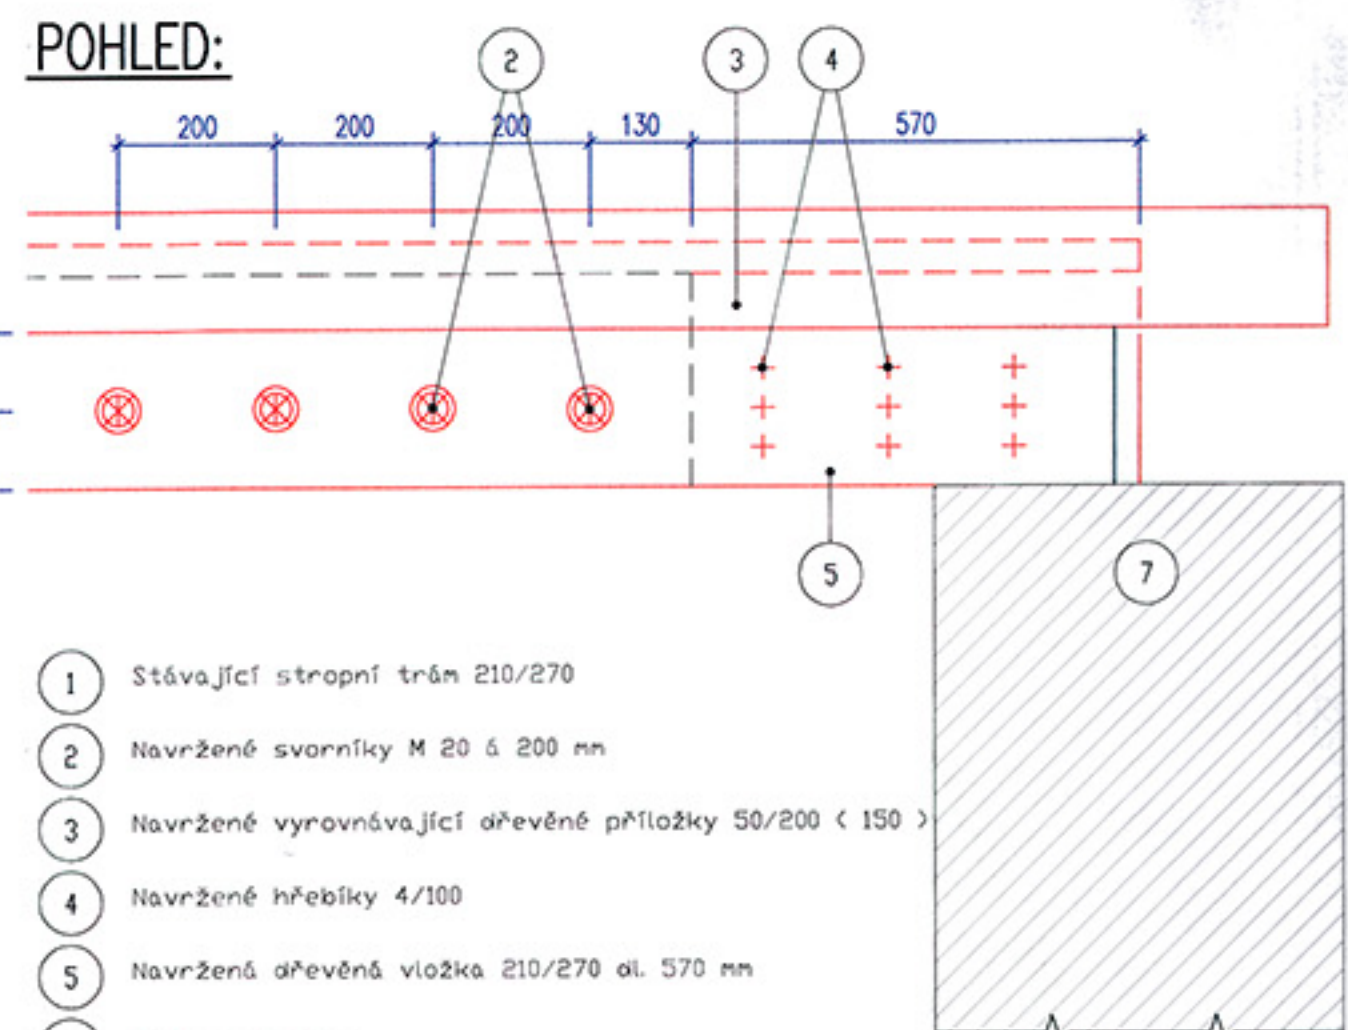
DETAIL NASTAVENÍ STROPNÍCH TRÁMŮ
